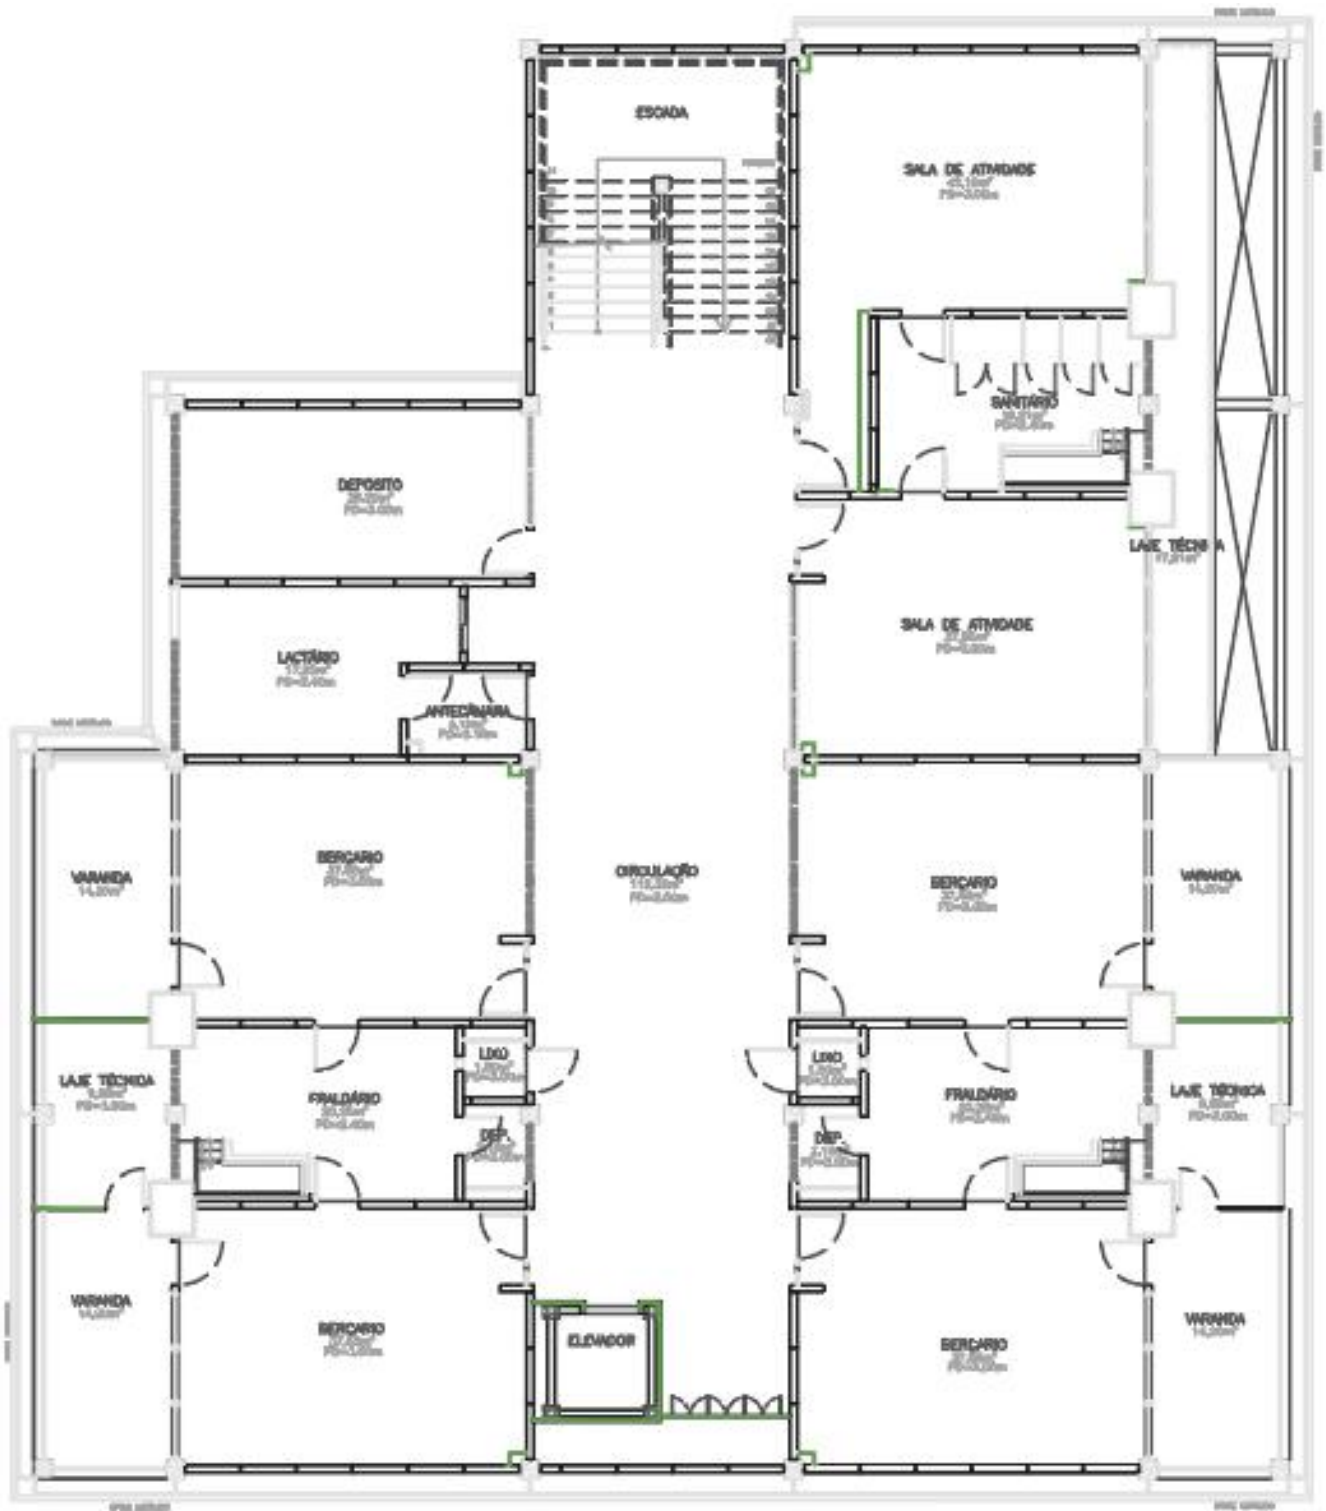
Planta 1º pavimento de um projeto padrão de EDI das Escolas do Amanhã
